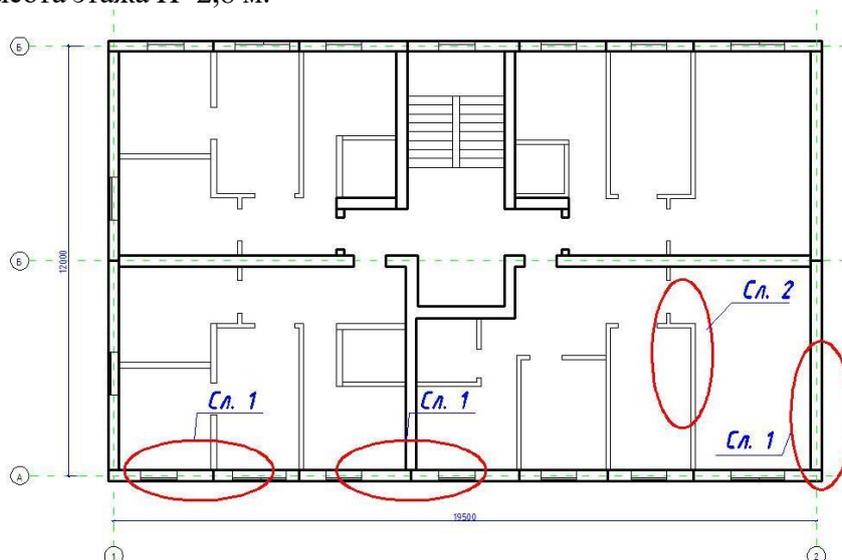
Схема расположения локальных разрушений типового этажа панельного здания
